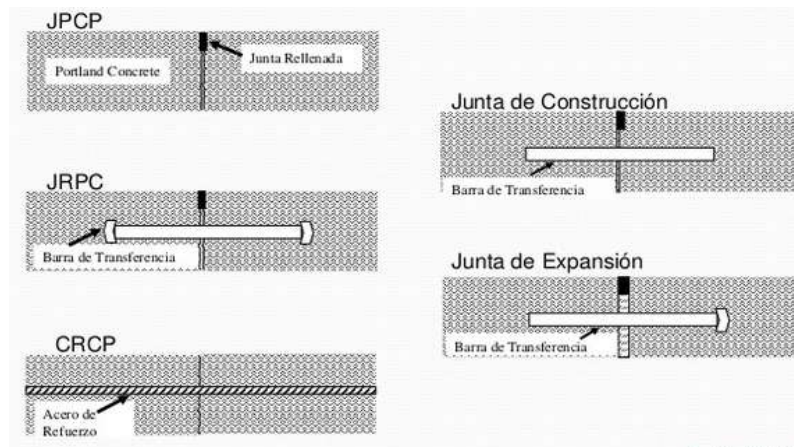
, Gráfica de Pavimento Rígido Pretensado.
